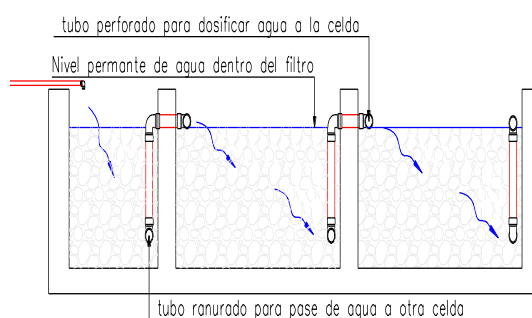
Vista de perfil (corte B-B') del sistema de filtración
